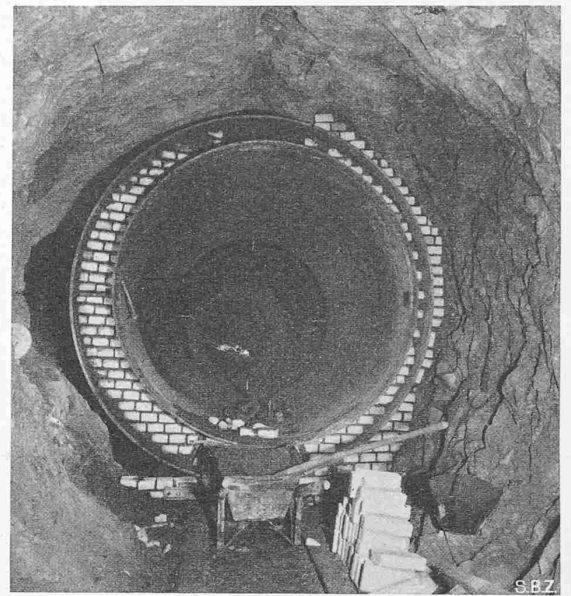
Hauptstrang der Verteilleitung. Doppelrohr. Abschalung durch Zementsteinmauerung vor dem Ausbetonieren des Zwischenraums
